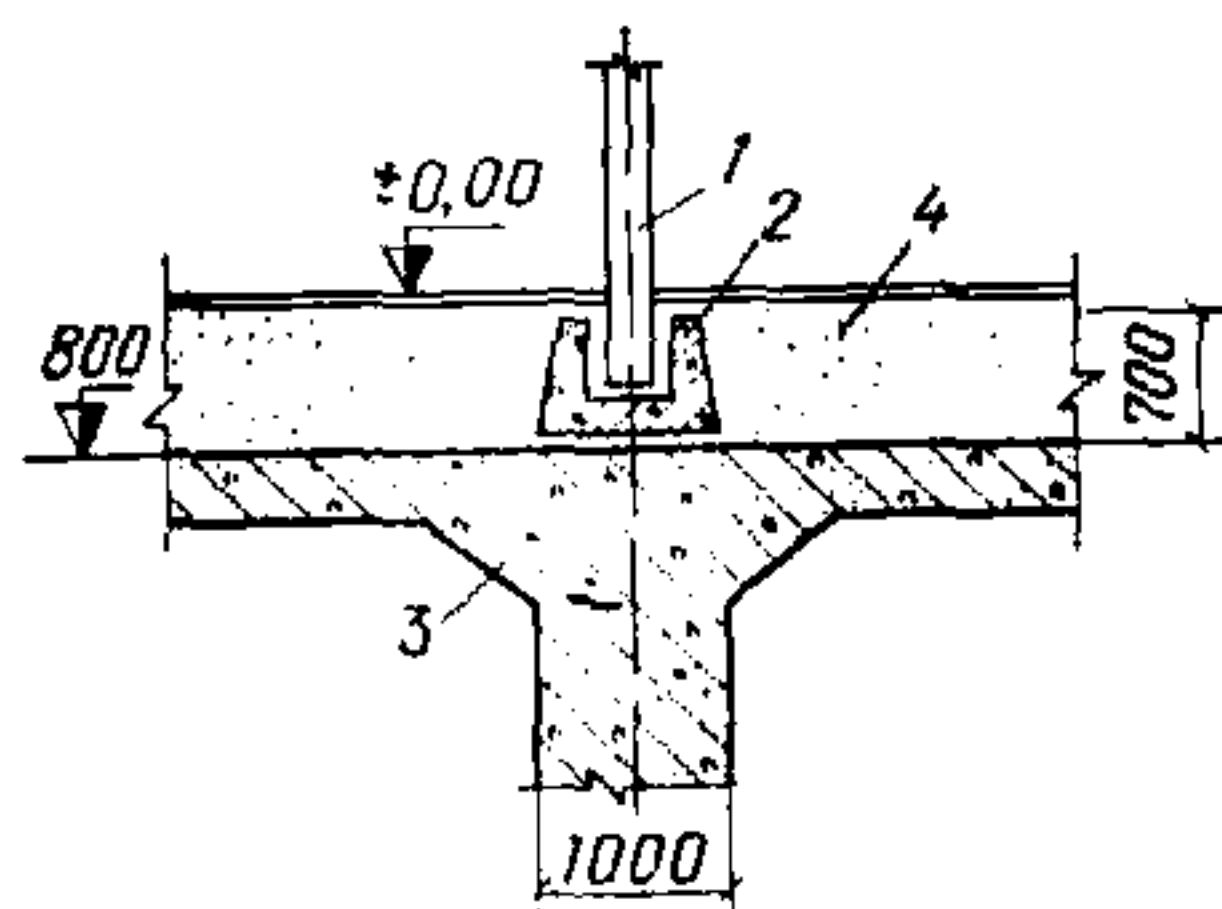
Схема опирания надземного каркаса на перекрытие убежища через стаканый фундамент
